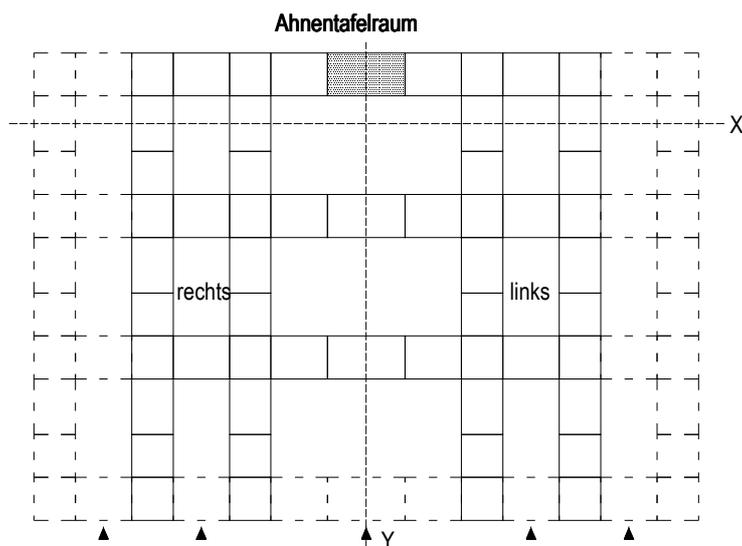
Grundriss-Schema des horizontal und vertikal erweiterten Wohnhofs
